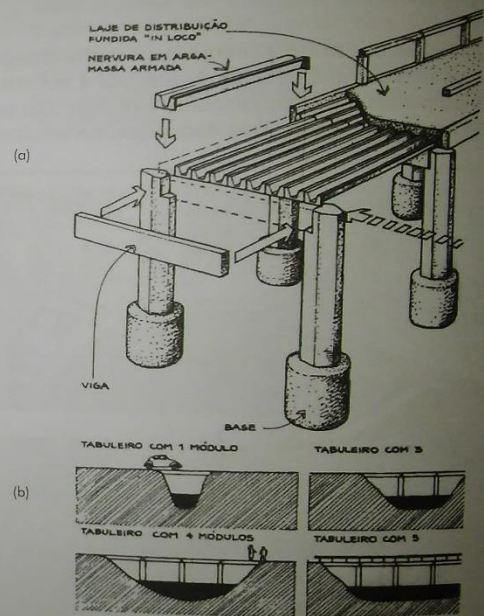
(a) Esquema construtivo de ponte eixível em argamassa armada. (b) Ponte fabricada com elementos pré-fabricados em argamassa armada.
